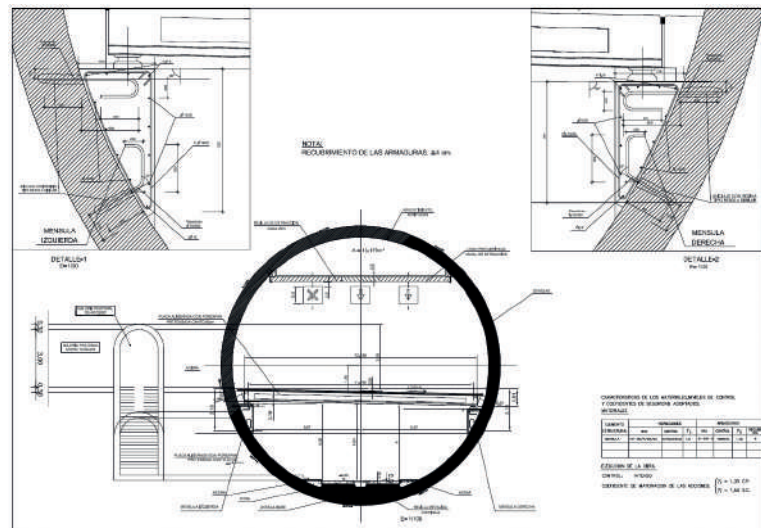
Sección tipo tuneladora-galería de emergencia
